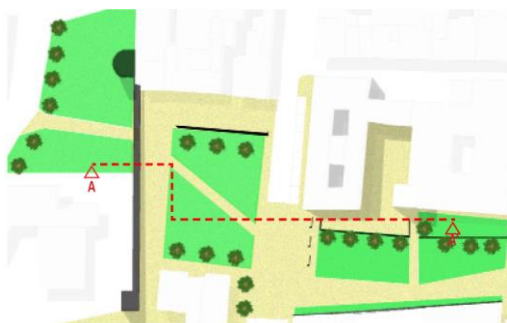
SEZIONE A-A' / STATO DI PROGETTO
